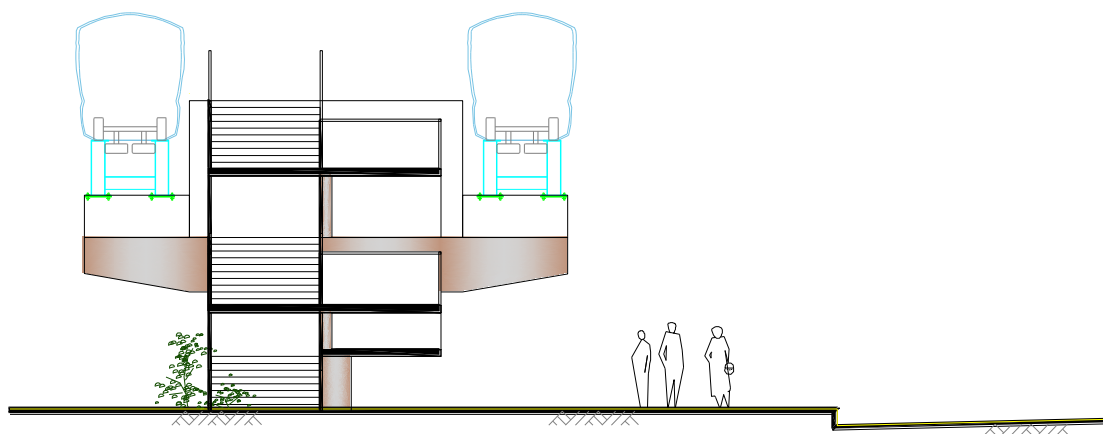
岛式车站（线间距 8.6m）剖面图
